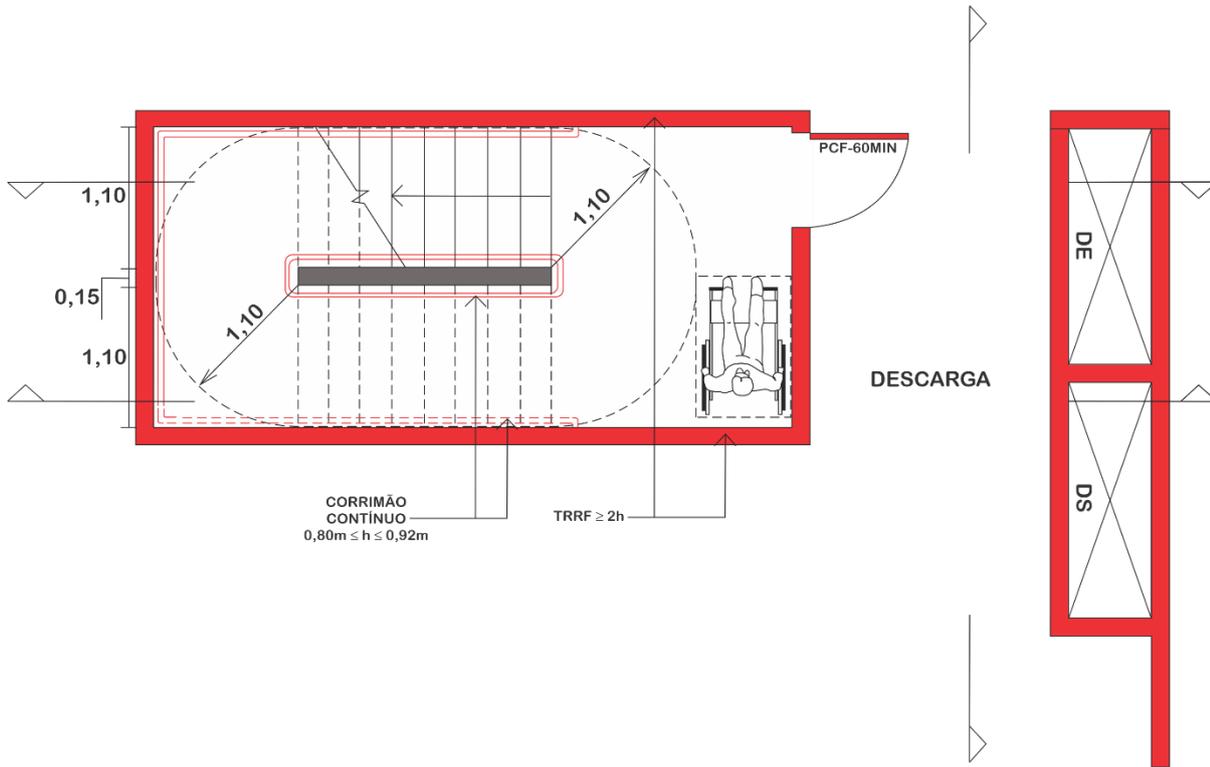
Escada Enclausurada de Prova de Fumaça (Pavimento Intermediário)
